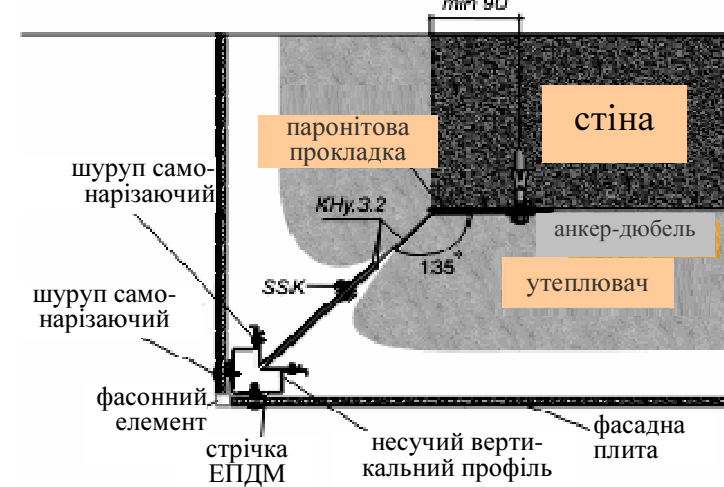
Кріплення фасадної плити на ріг будинку (1-й варіант)
